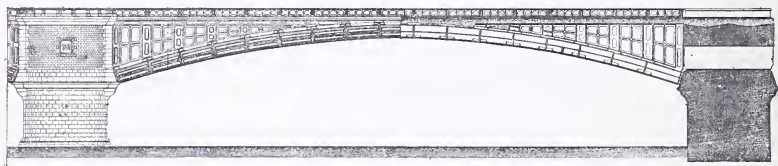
Pont de Tarascon. (Élévation et coupe longitudinale d'une arche.)
